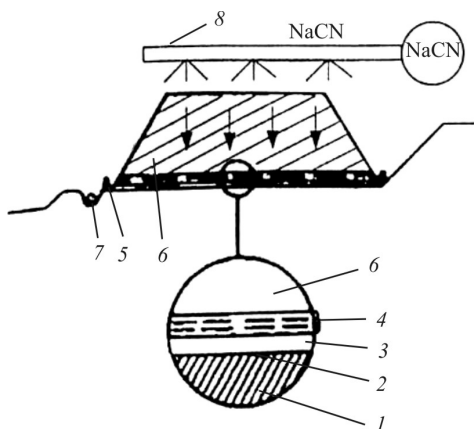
Типовое строение кучи: 1 – фундамент покрытия; 2 – полимерная пленка; 3 – слой песка (до 50–100 см); 4 – предохранительное покрытие (до 50 см) с перфорированными трубами; 5 – берма (высотой до 60 см); 6 – куча (штабель); 7 – дренажная траншея с трубой; 8 – оросительная система
